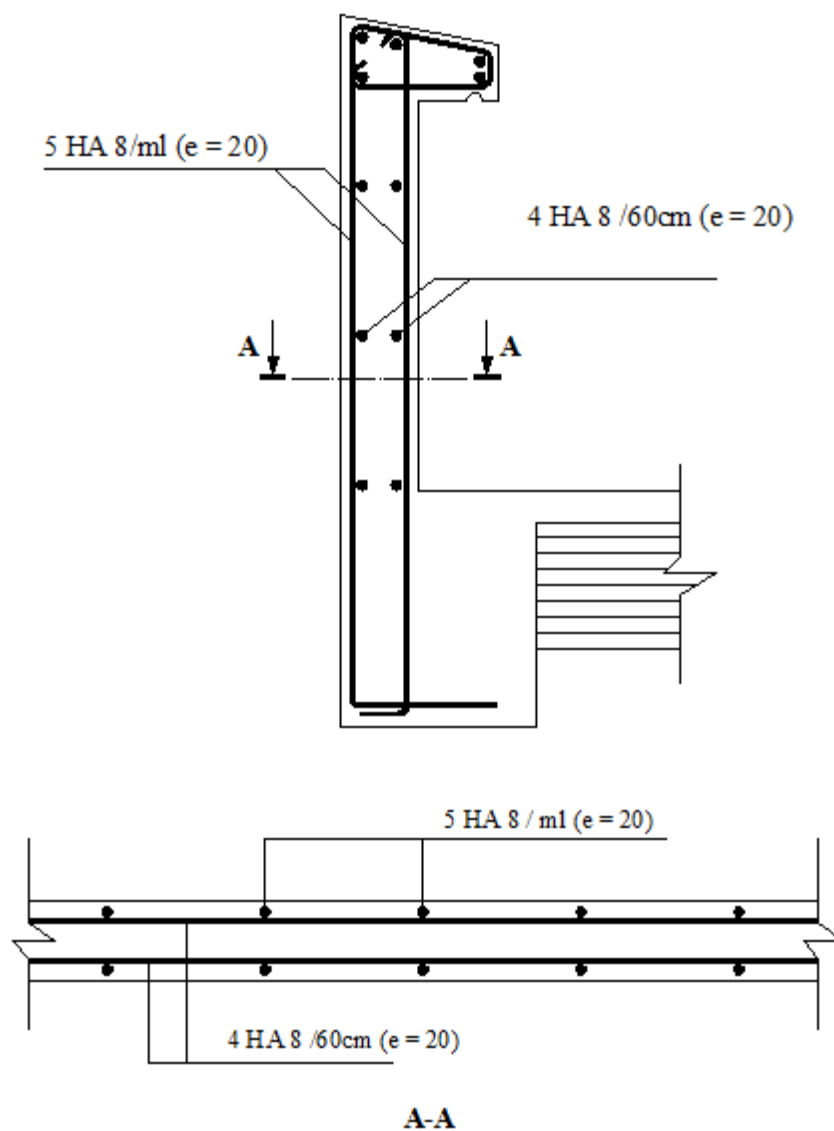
Schéma de ferrailage de l'acrotère.
